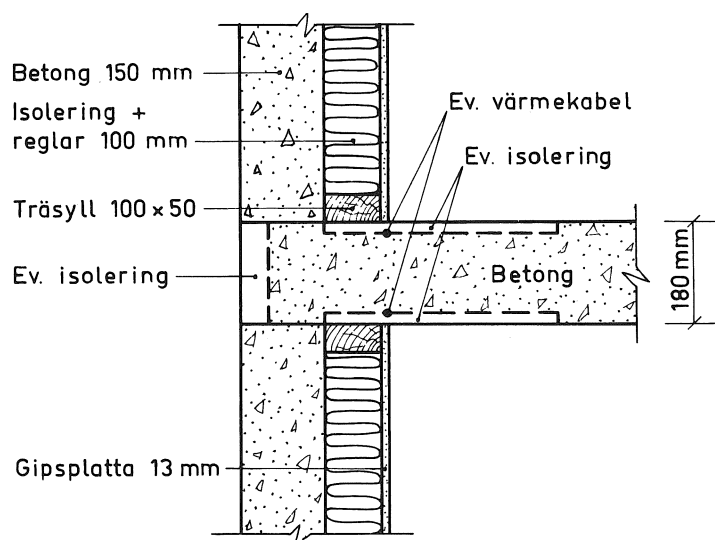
Konstruktionsalternativ vid yttervägg med bärande betong. Konstruktionen ofullständig bl.a. med avseende på fuktskydd.
